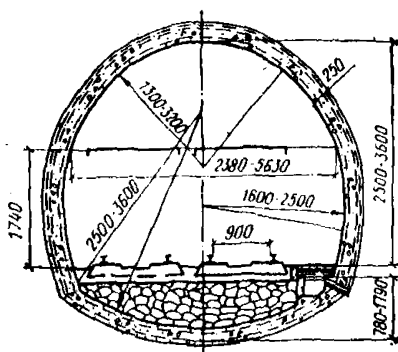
Замкнутая железобетонная крепь из двутаврового профиля с бетонным заполнением КДЗ, Донгипрошахт
